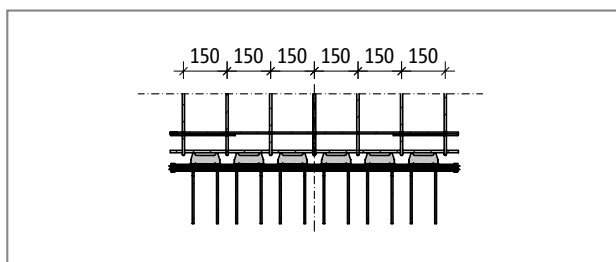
Schöck Tronsole® tipo T: passo armatura pari
